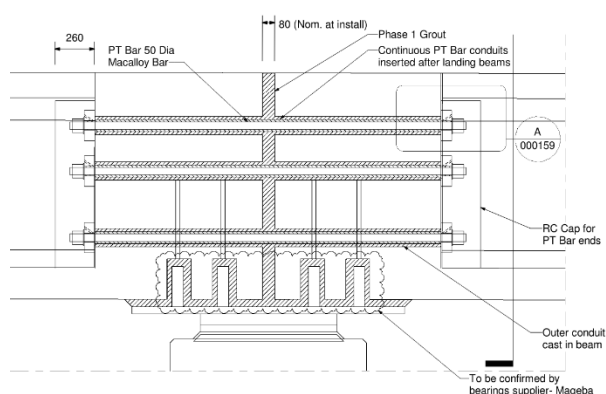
Sección longitudinal de la unión entre dos vigas consecutivas mediante el uso de barras cortas de pretensado.
